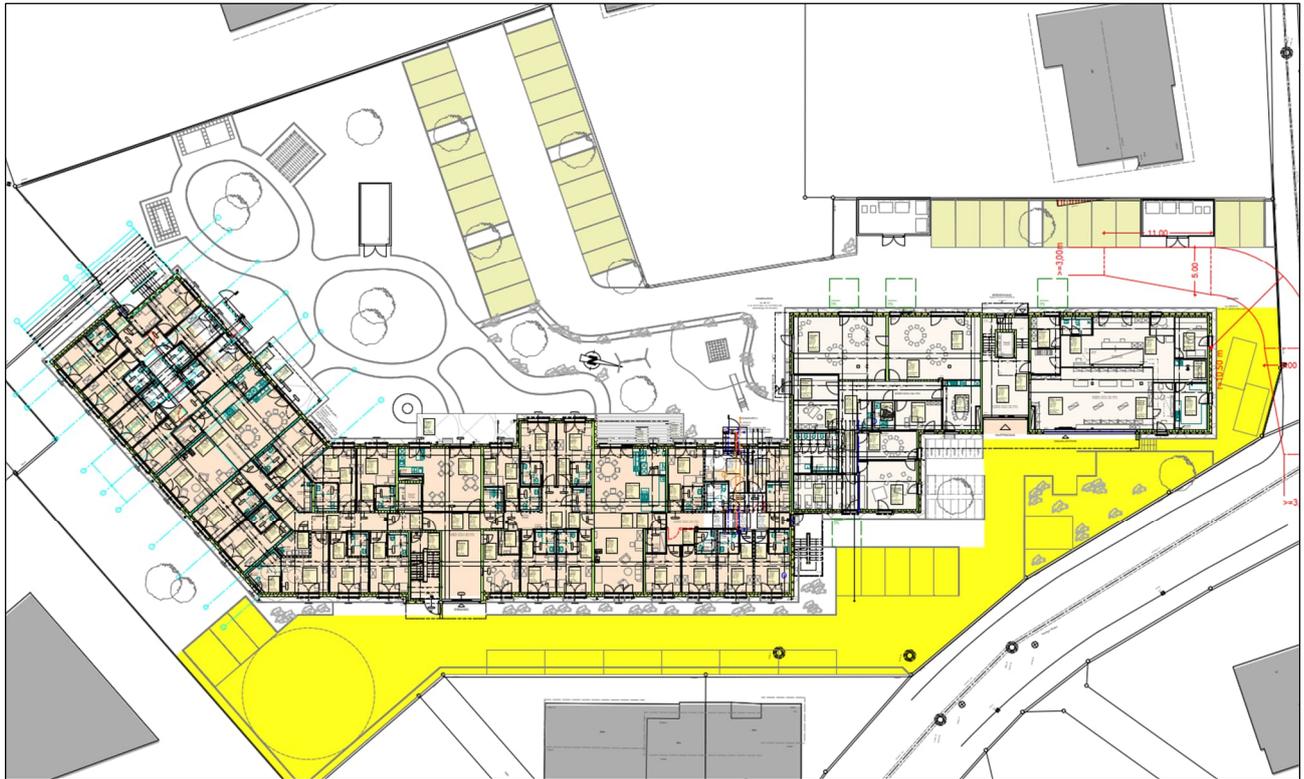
Lageplan öffentliche Stellplätze, Stand 16.05.2024, Schreiber Planung
